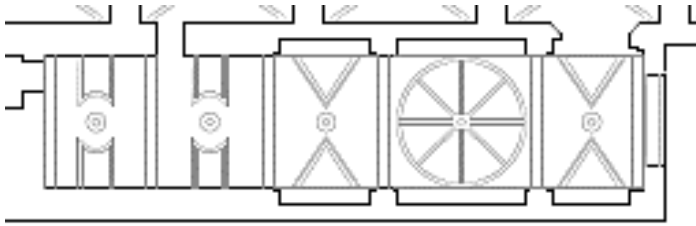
Detalle de la planta de la Capilla de la Comunión en sección. Imagen propia 20/08/17
